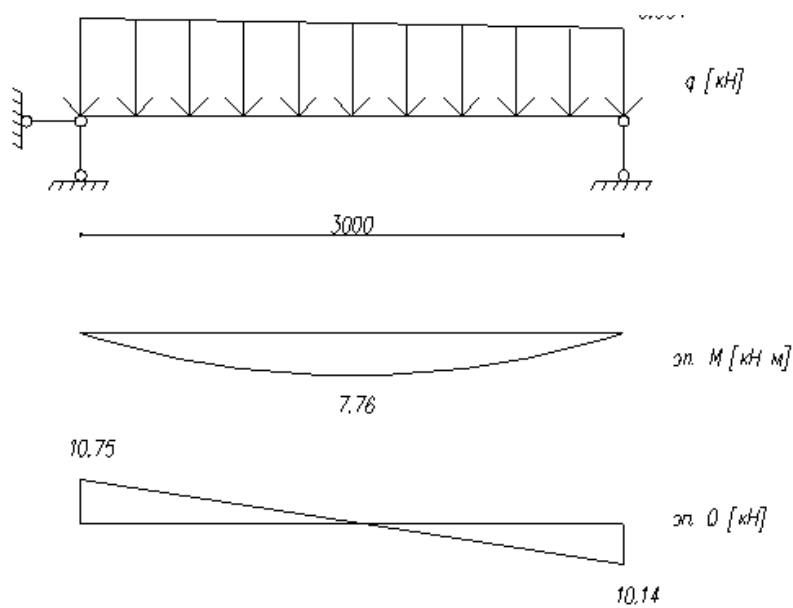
Розрахункова схема і внутрішні зусилля
